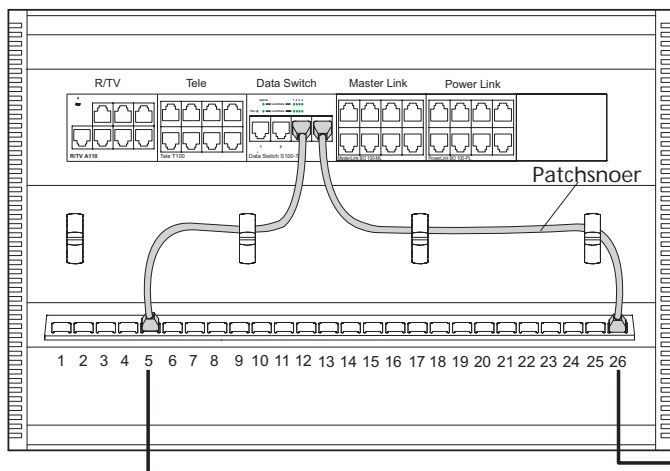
Uitgang nr. 26 voor telefoonaansluiting
